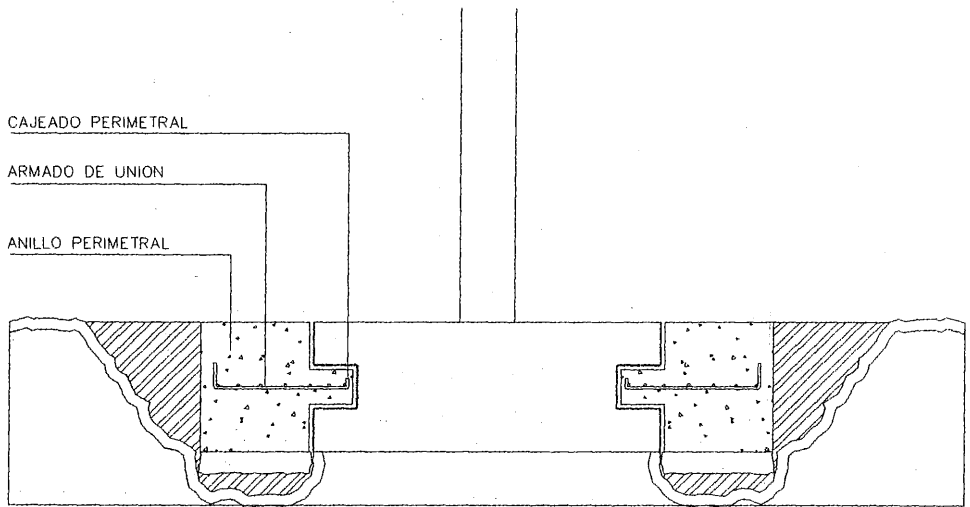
Recalce superficial de zapata aislada aumentando la superficie de apoyo mediante anillo perimetral unido por cajeados laterales.
